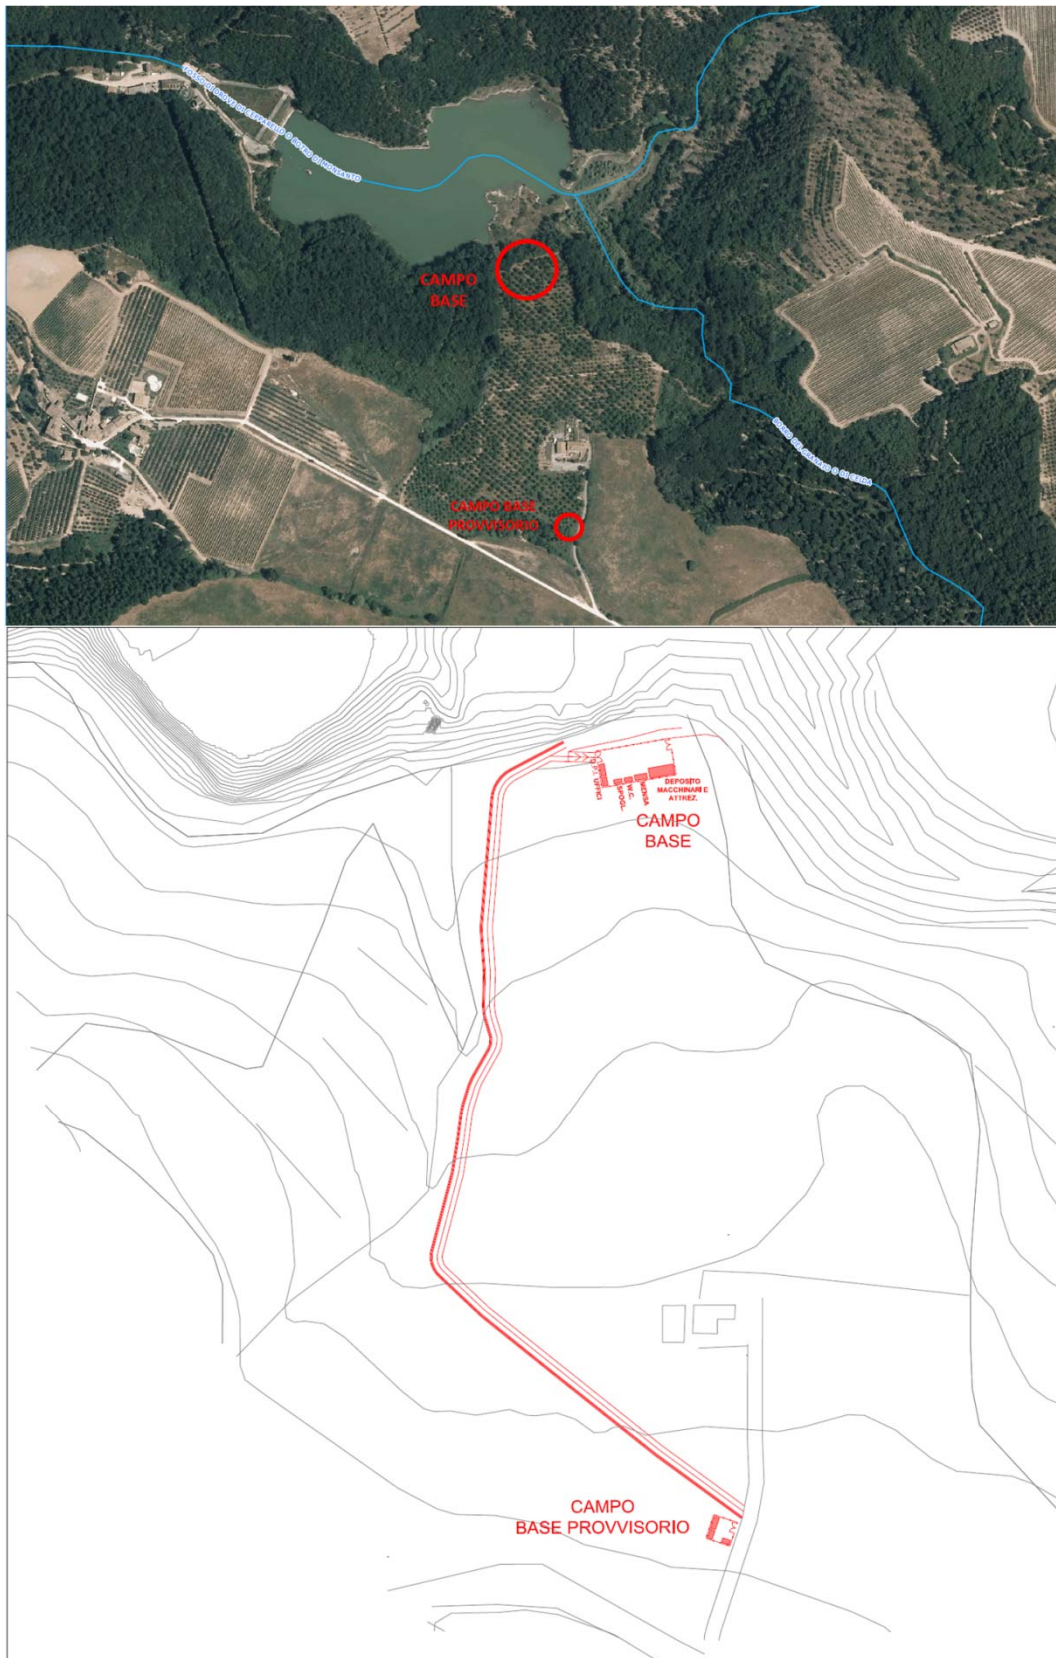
Localizzazione area di cantiere e pista di accesso.
